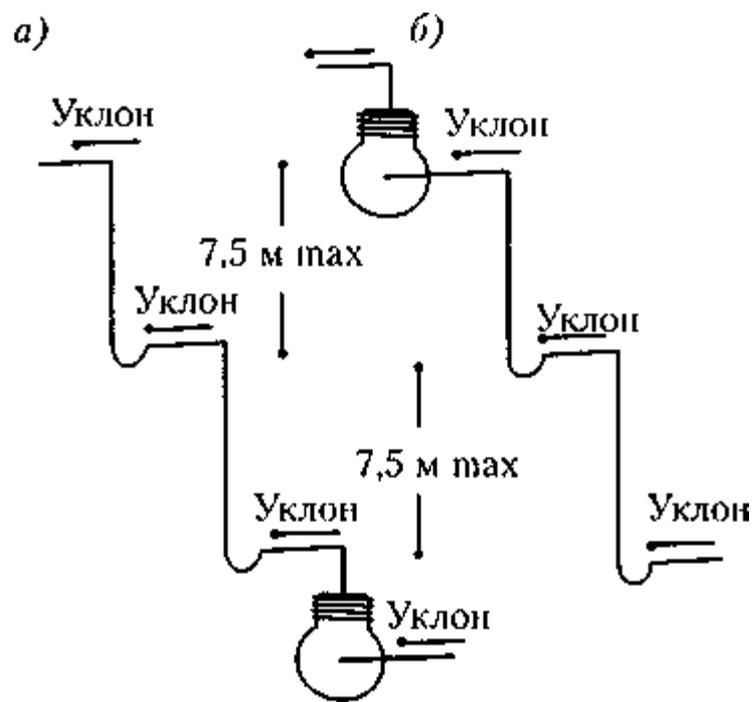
Схема установки маслоподъемных петель на восходящих участках трубопроводов длиной более 7,5 м: а- нагнетательный трубопровод; б- всасывающий трубопровод
